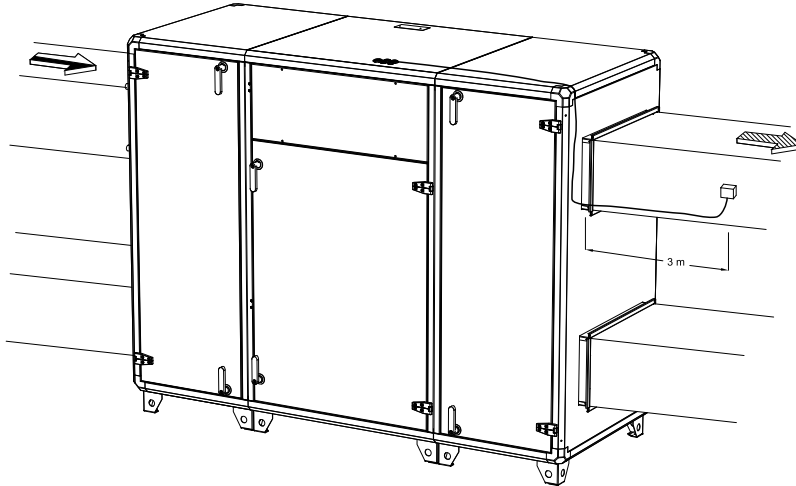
Installierter Zuluftsensor (Gerät mit rechtsseitigem Anschluss)
